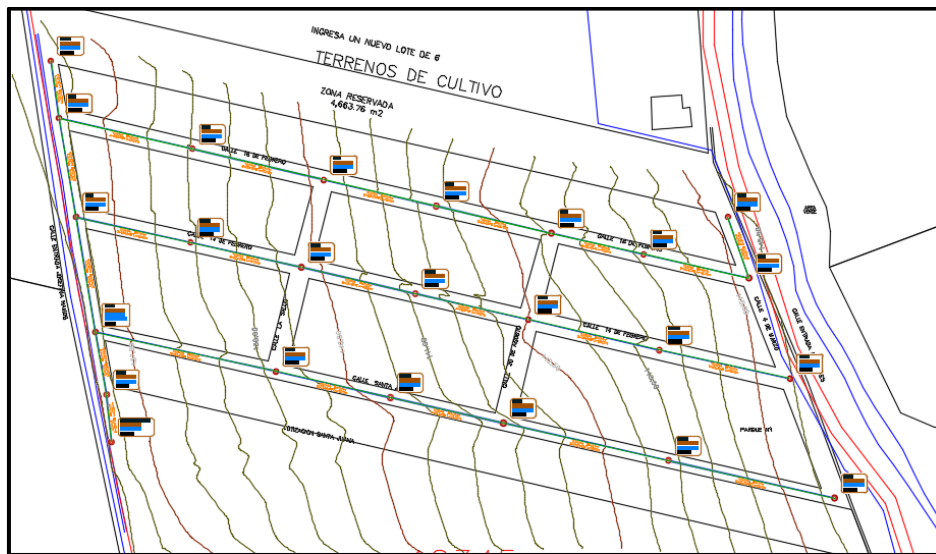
Planteamiento del diseño del sistema de alcantarillado convencional
